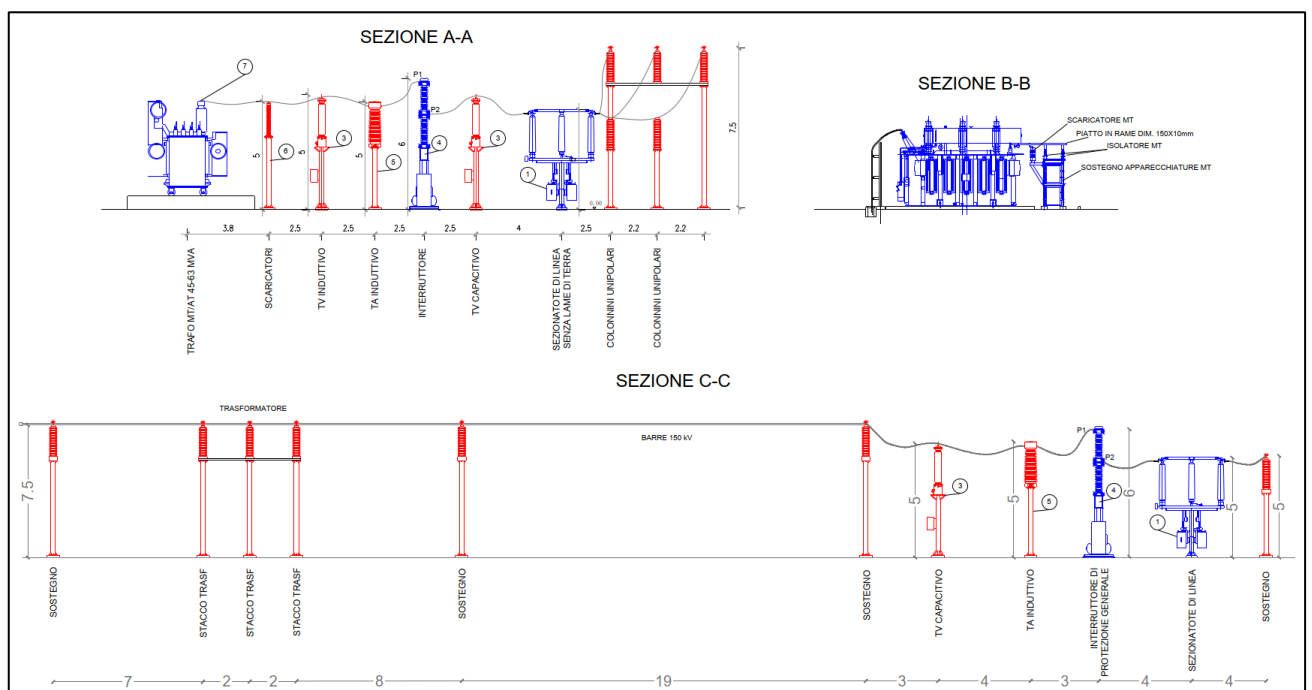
Vista in sezione delle apparecchiature da installare nella SU
